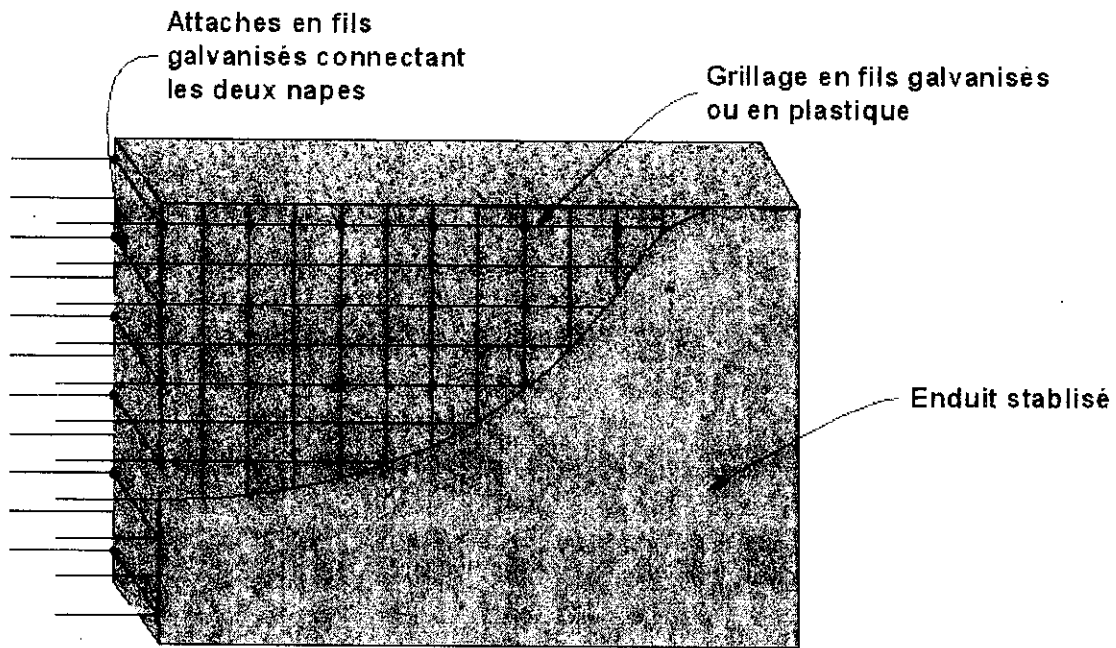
Renforcement latéral des murs par deux nappes en grillage
